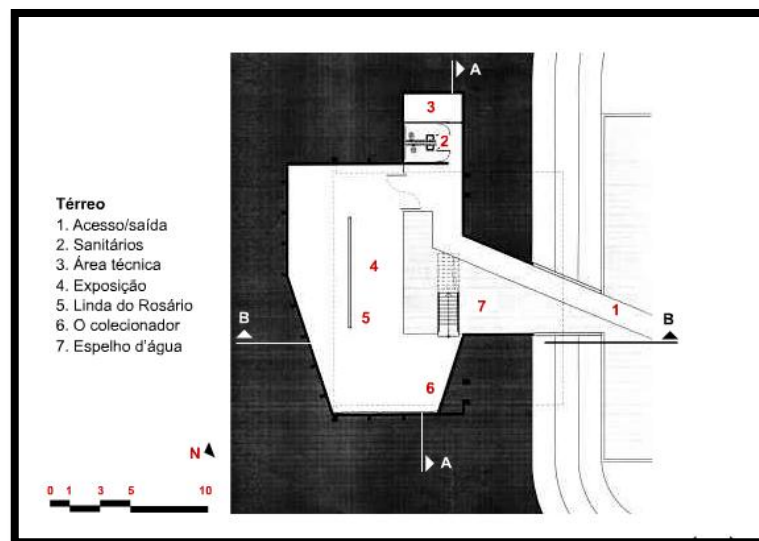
Planta Baixa térreo da Galeria de Arte Adriana Varejão.
